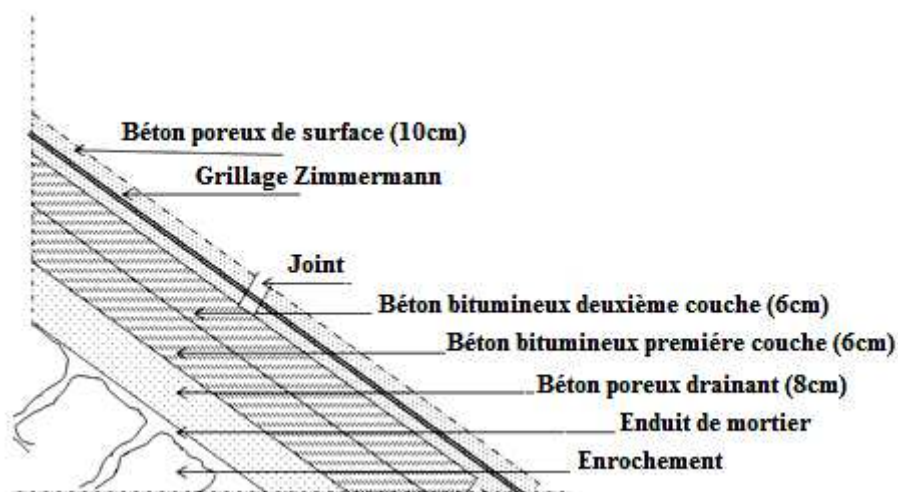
Coupe du masque en béton bitumineux du barrage Ghrib (Djemili, 2006).
